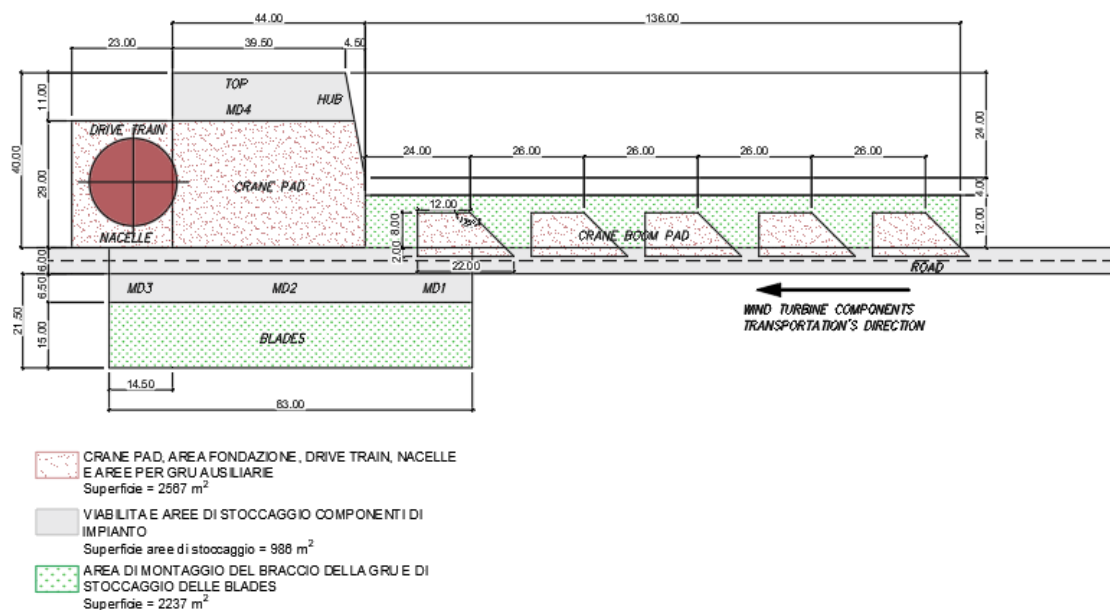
Layout della piazzola dell'aerogeneratore in fase di costruzione
